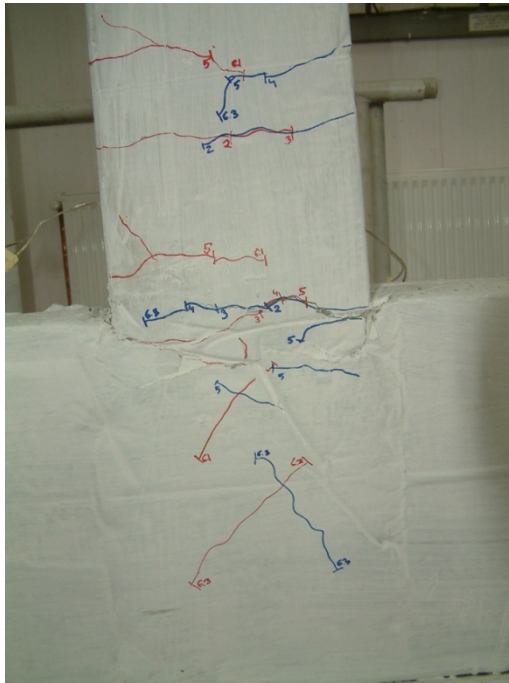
Distribuția fisurilor la bază pentru elementul C5C
